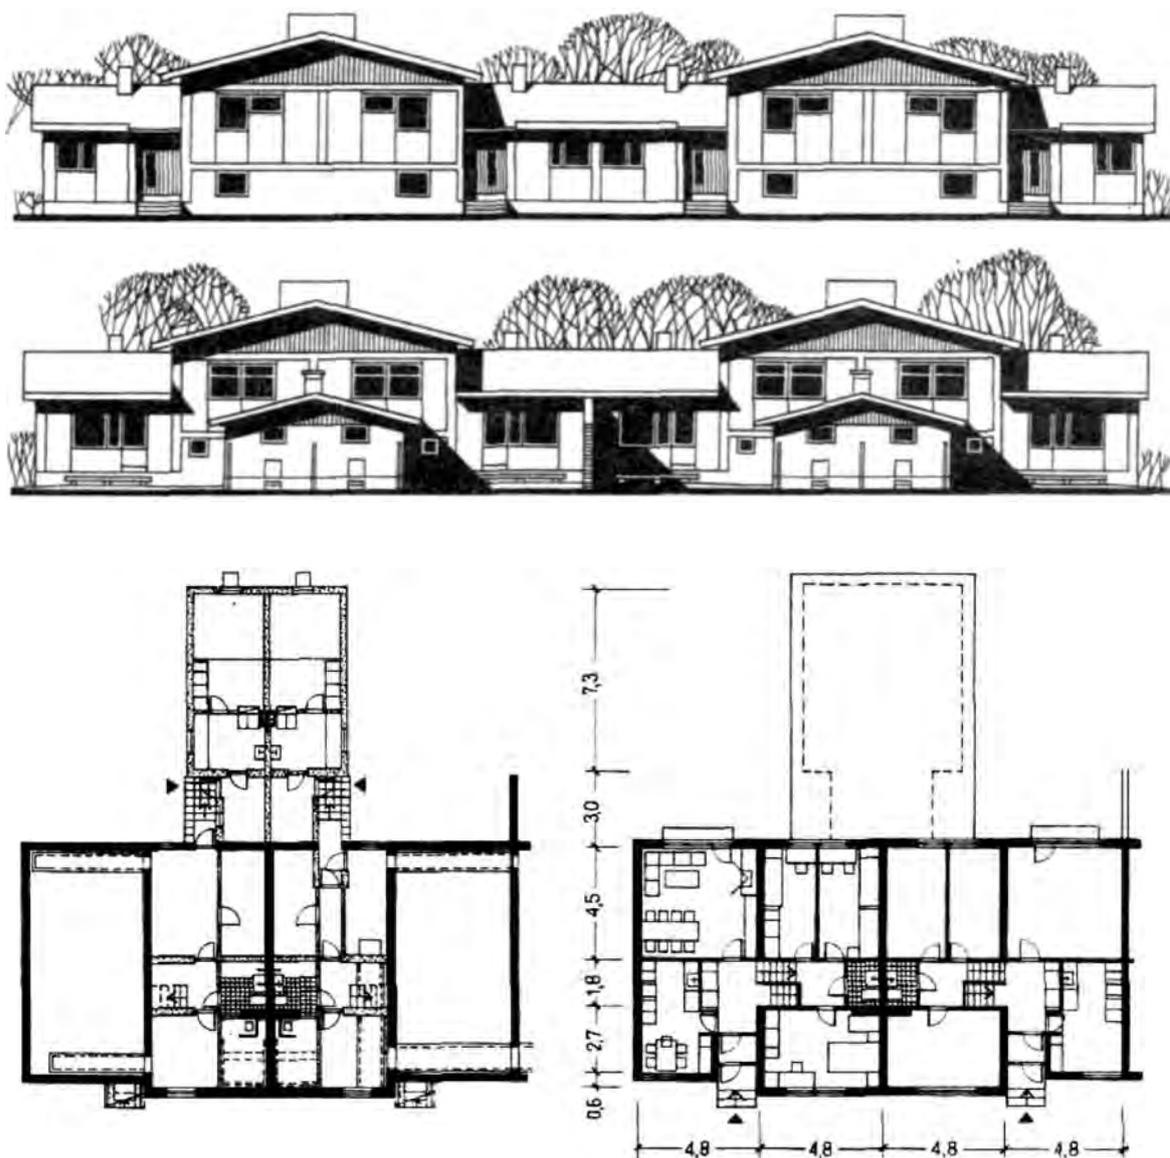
Двухквартирный блок с четырехкомнатными квартирами в двух уровнях (с перепадом на пол-этажа) и цокольным этажом. Фасады, планы
